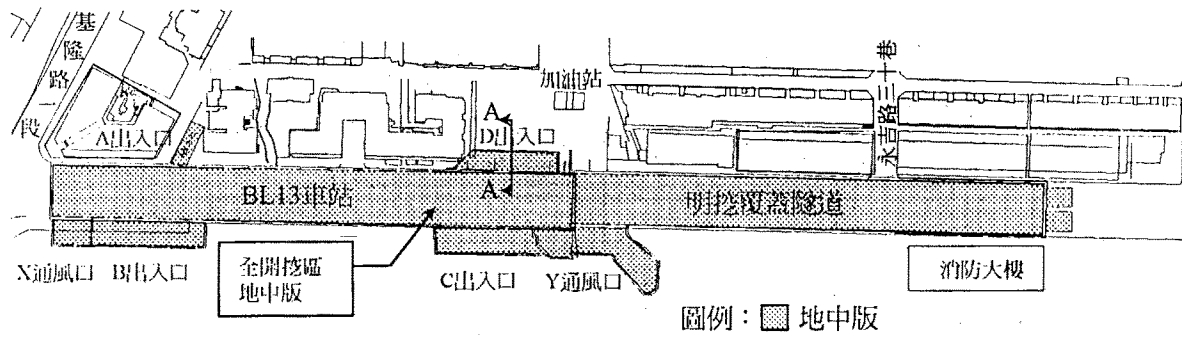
CN257標支撐穩定設施平面及剖面示意圖(地中版)
